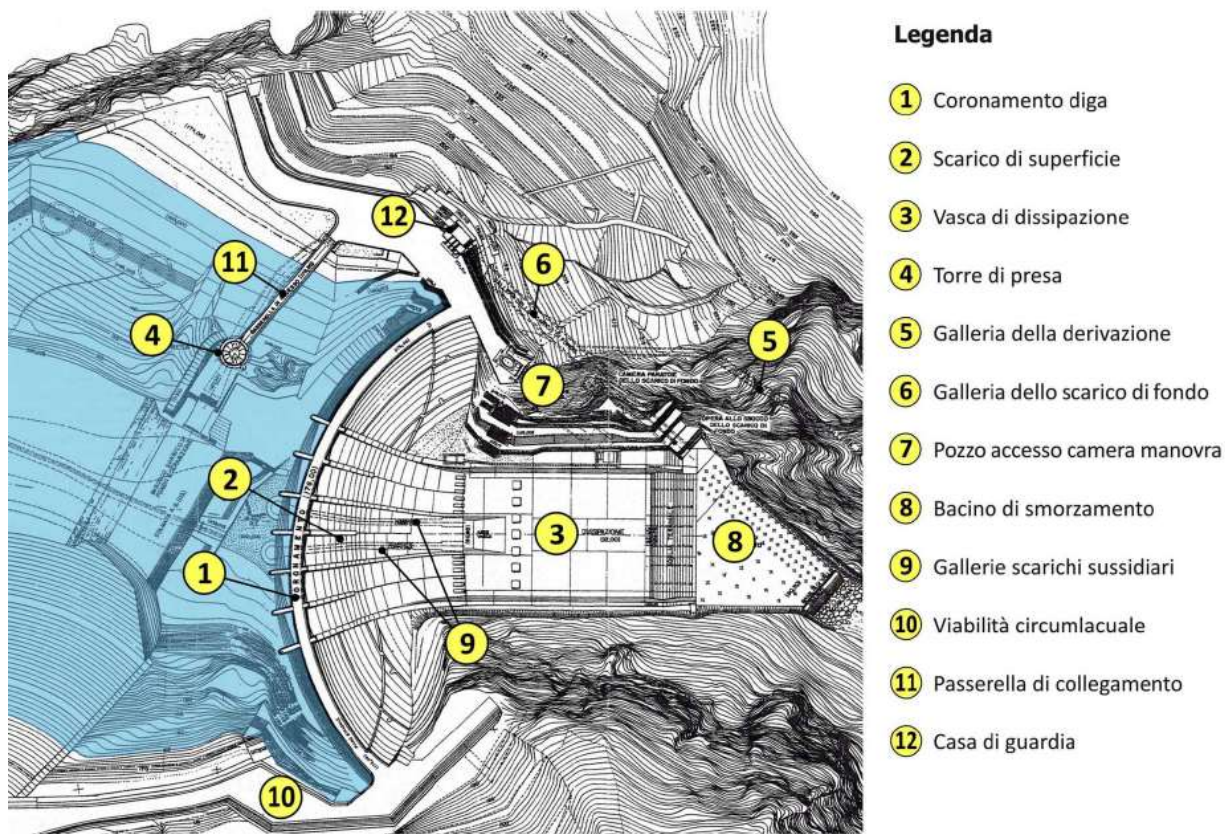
Planimetria con indicazione delle opere accessorie e manufatti di servizio.
